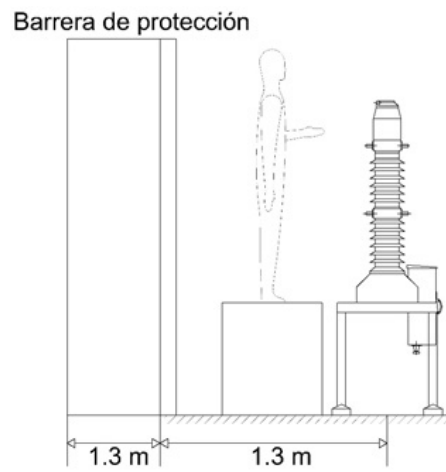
Aislamiento con barrera de protección (para subestación en la Ciudad de Querétaro).
